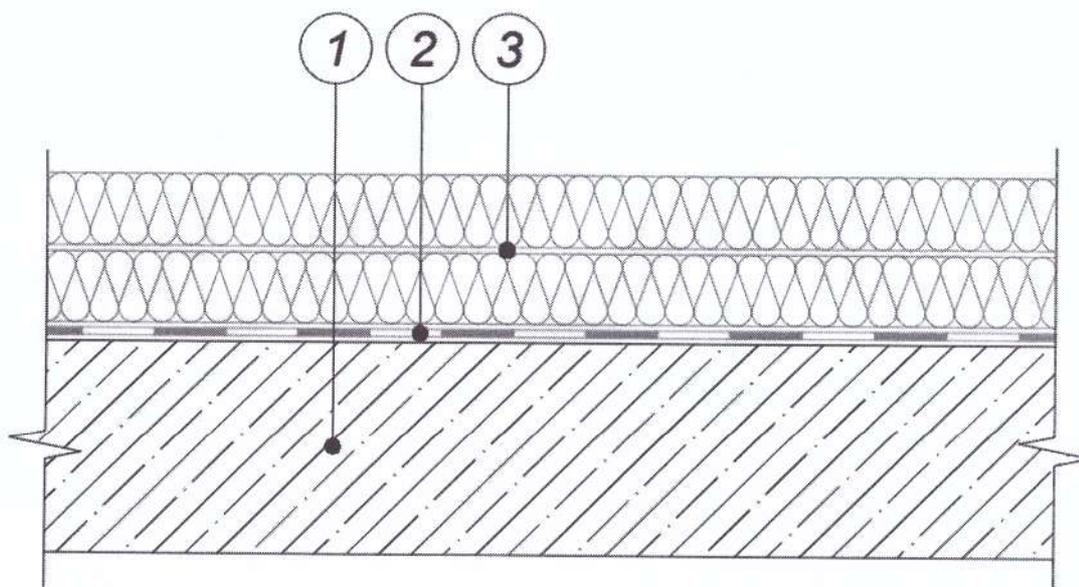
Схема конструктивного исполнения железобетонного чердачного перекрытия с системой утепления ТН-Чердак КВ (вариант 20)
